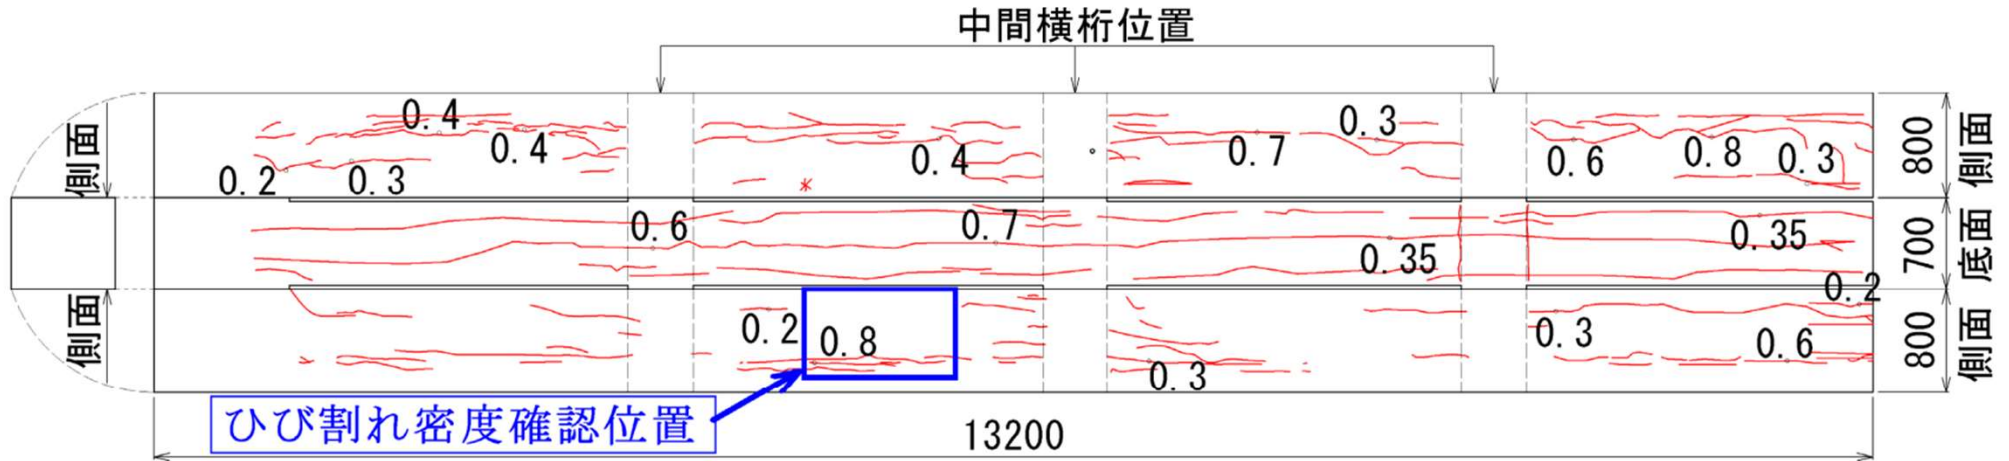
劣化試験桁 G47 のひび割れ状況展開図 (単位 : mm)
